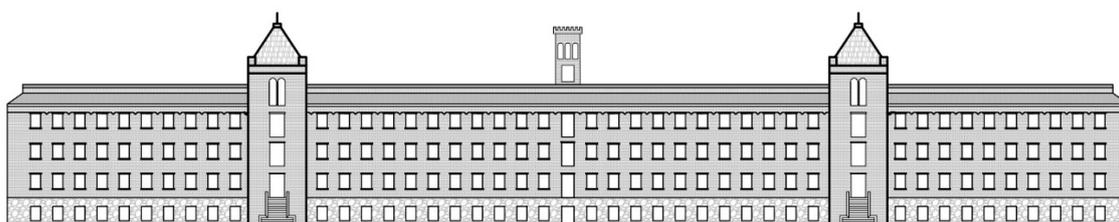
Elevação frontal da fachada principal, sem escala. Fonte: Autora, 2020.
